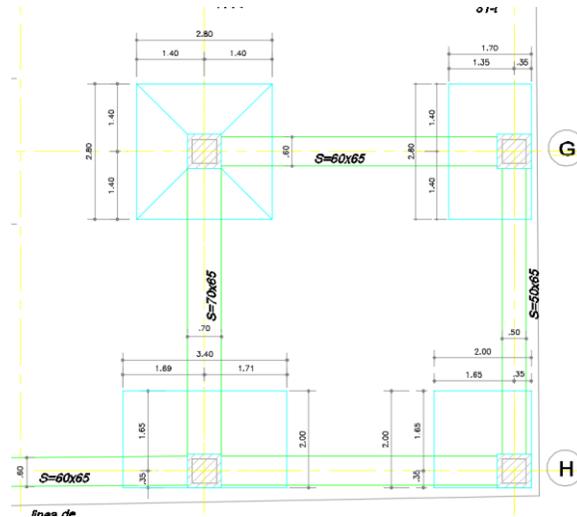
Vista parcial del plano general de zapatas y vigas de cimentación entre los ejes H-G entre 1-2.
